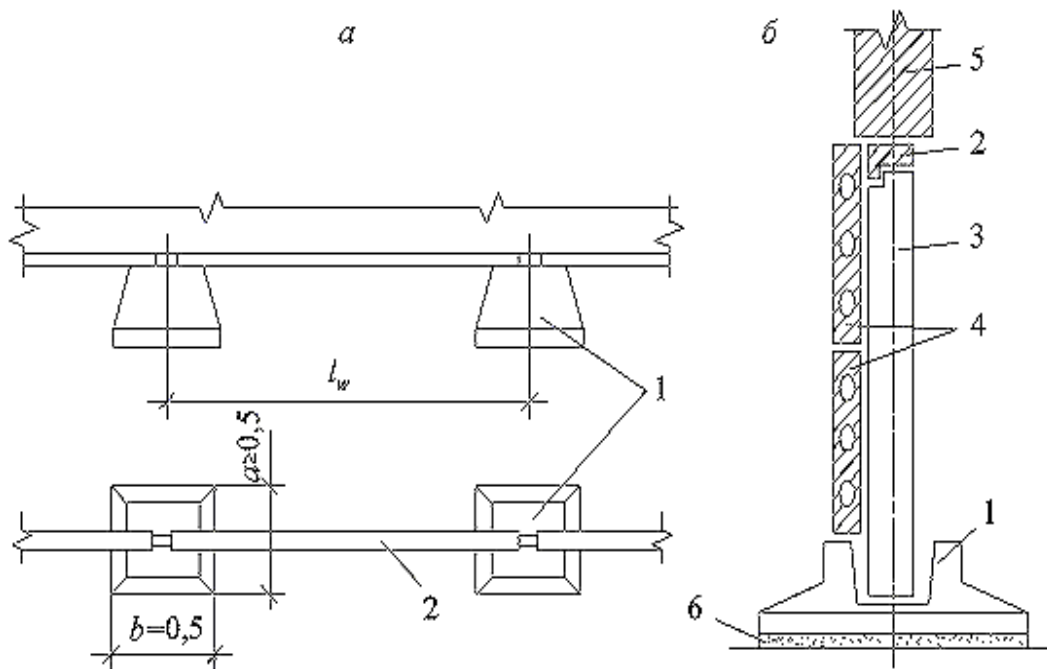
Стовпчасті фундаменти під стіну: *а* – в безпідвальних будівлях; *б* – у будинках з підвалом; 1 – фундамент; 2 – фундаментна балка; 3 – стовбур; 4 – панелі; 5 – стіна; 6 – підготовка
